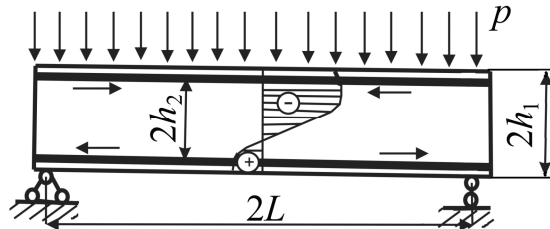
Схема навантаження залізобетонної балки з попередньо напруженою арматурою.
